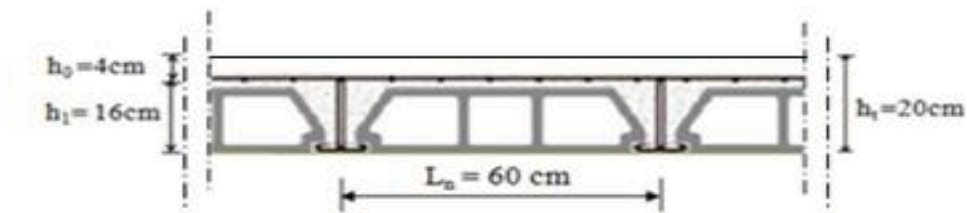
Coupe transversale d'un plancher à corps creux
